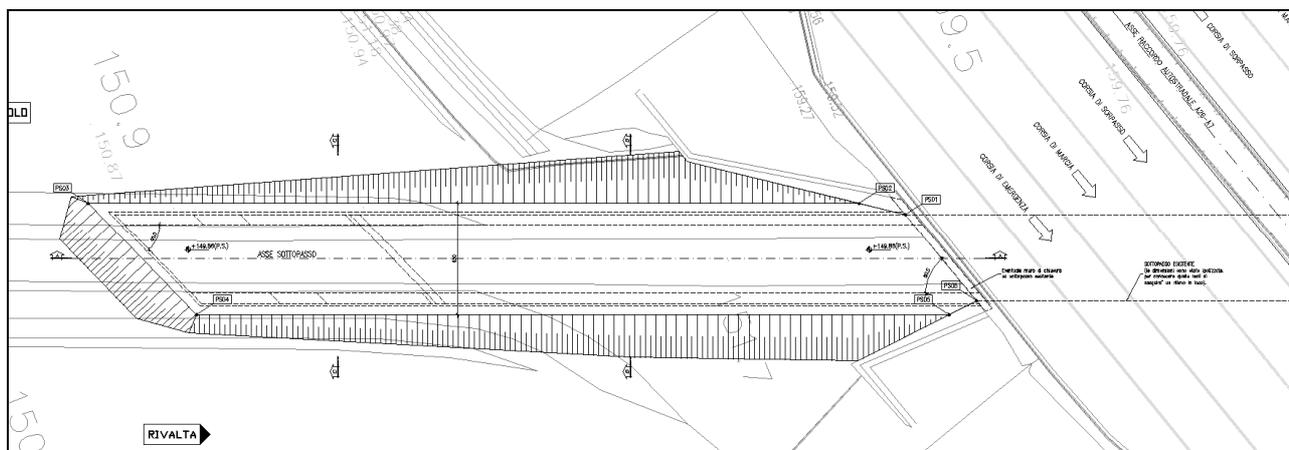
Prolungamento tombino viabilità secondaria. Planimetria scavi
